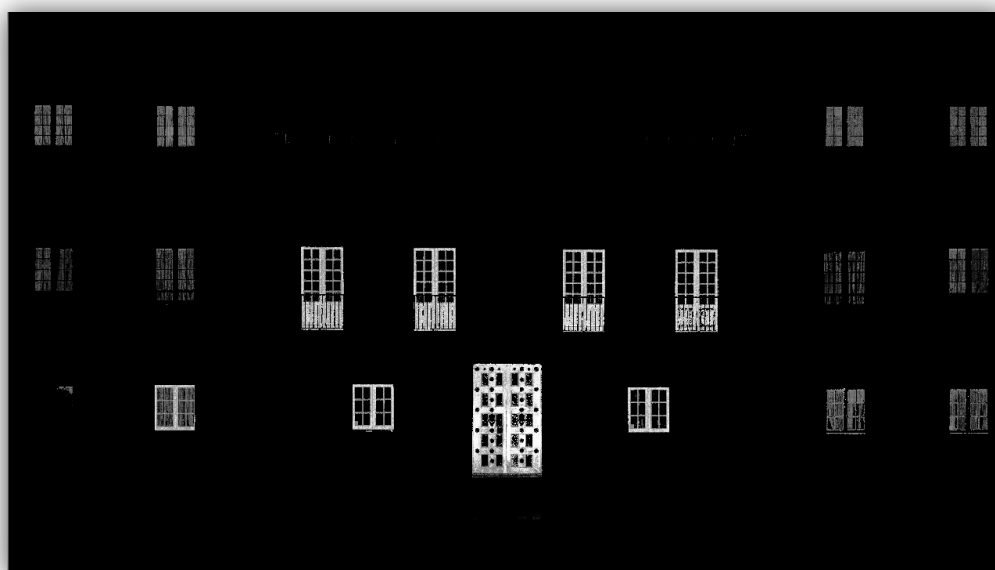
PLANO SEGMENTADO - JANELAS E PORTA
